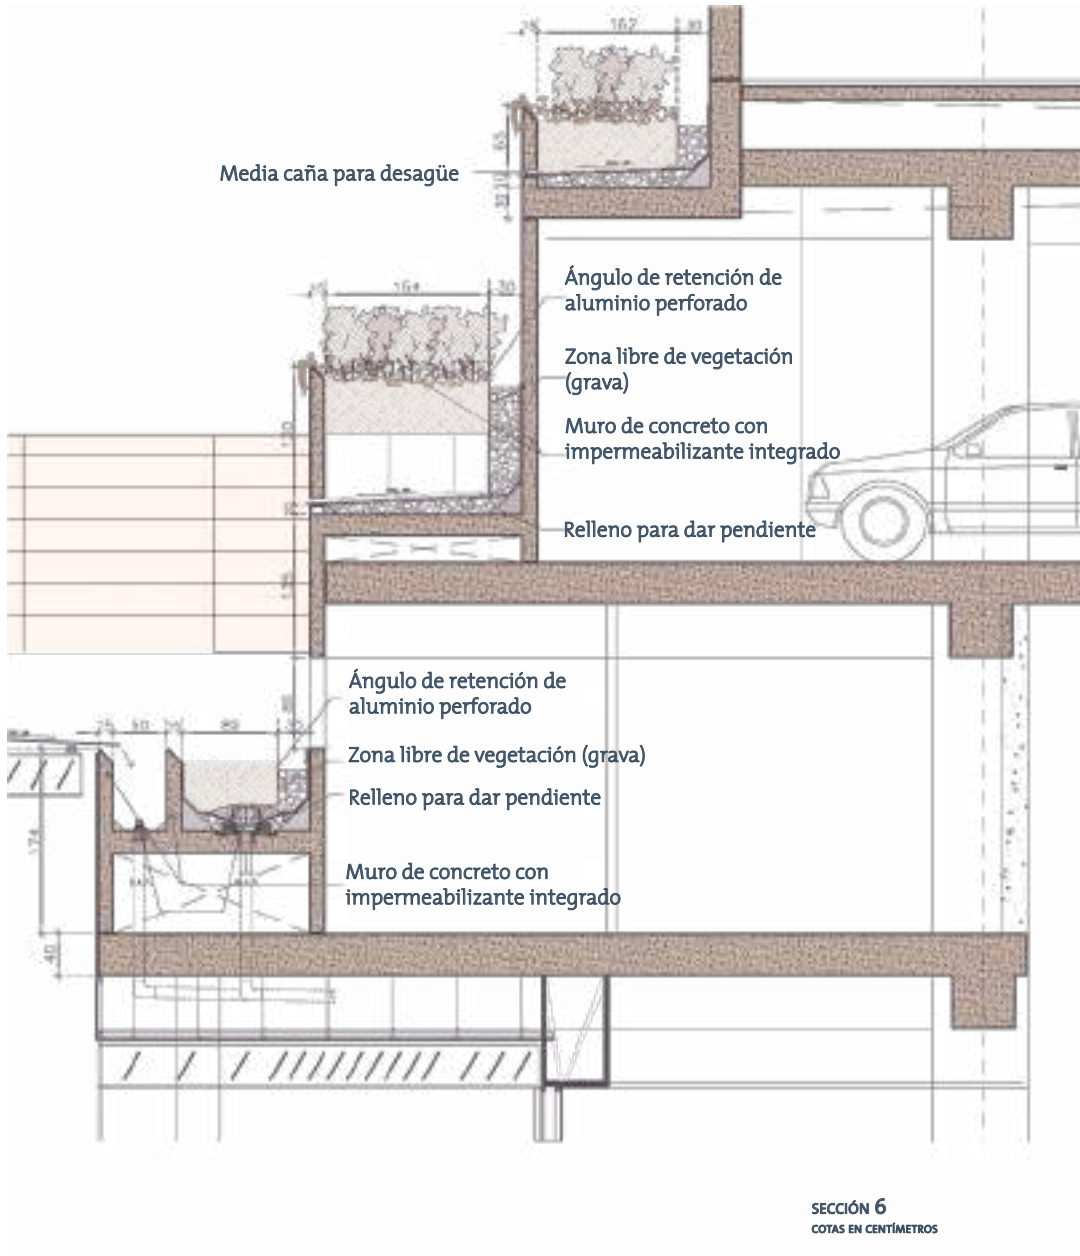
Detalles de jardineras sobre estructura, conjunto Miyana, Polanco, Ciudad de México
